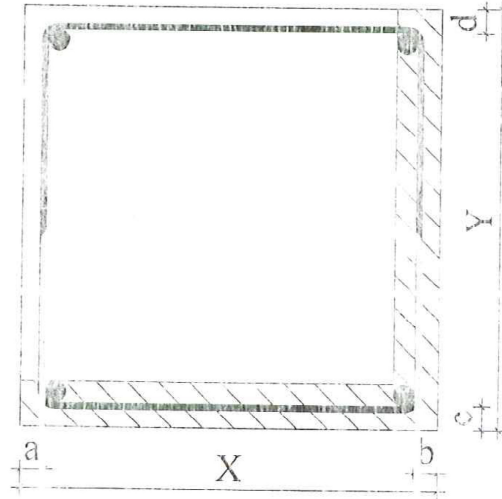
Paspayı sıyrılarak yapılan kolon donatı tespit tutanağı-yapı elemanı TT-Z-P2.
